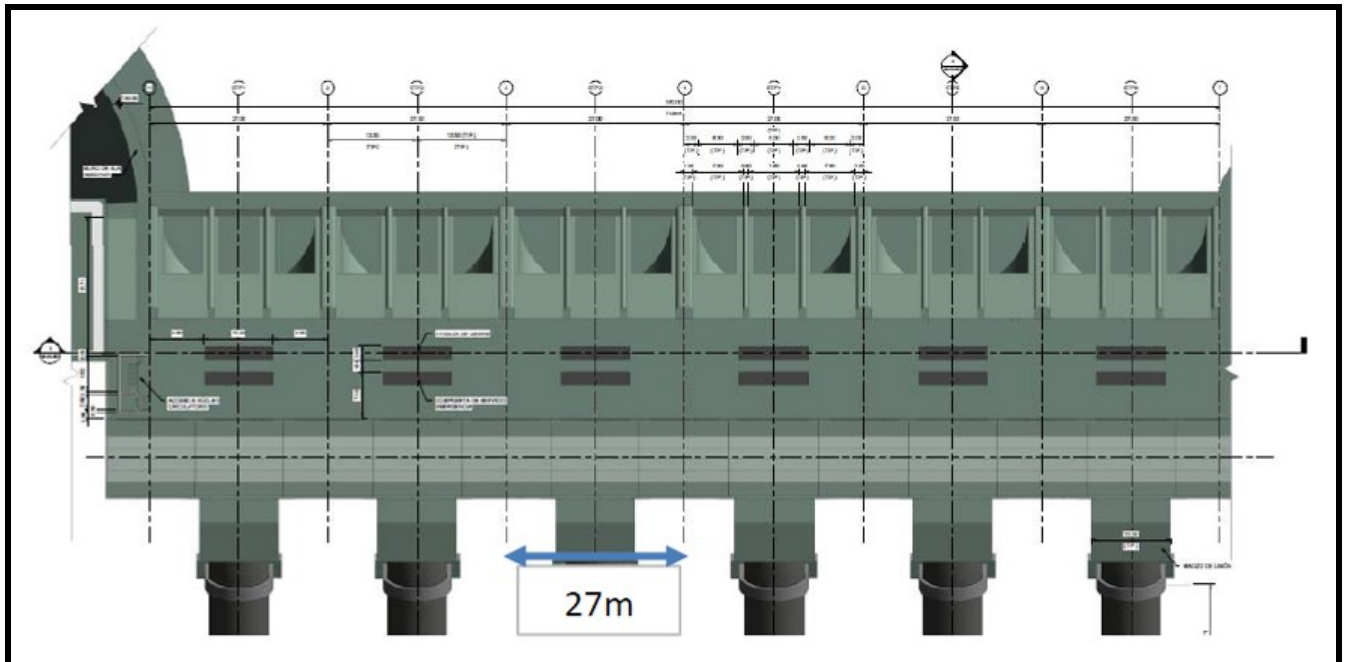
Planta y corte de la estructura de desvío/descargador de fondo
